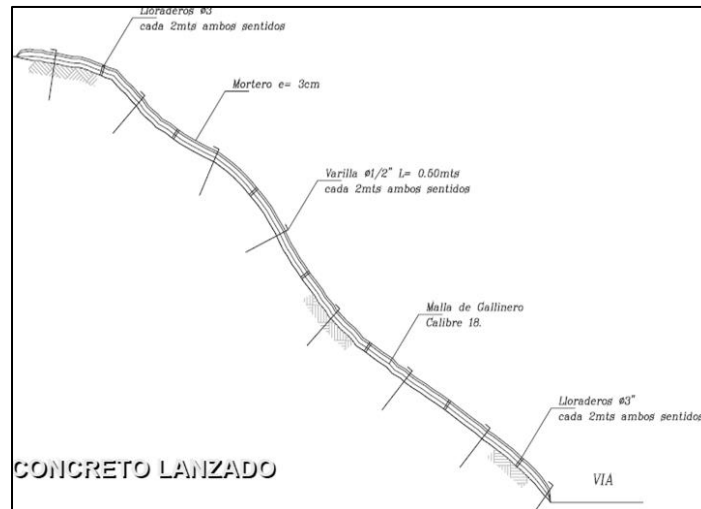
Estructura de concreto lanzado (SUAREZ DIAZ)
